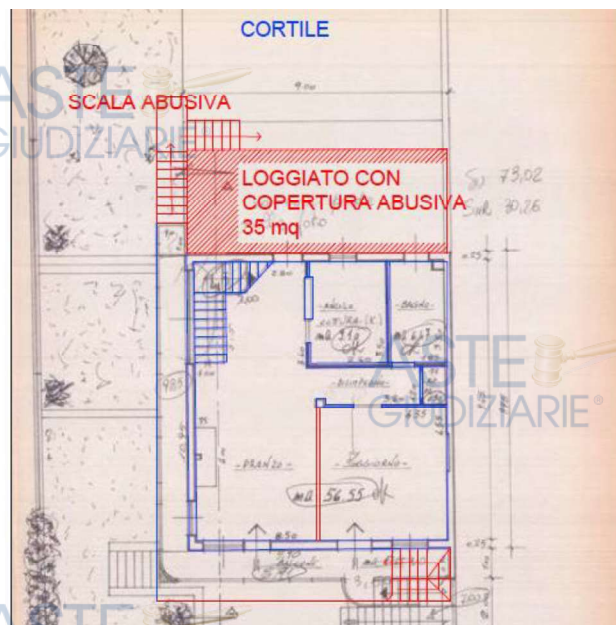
planimetria al piano terra con l'indicazione degli abusi e delle difformità in rosso
